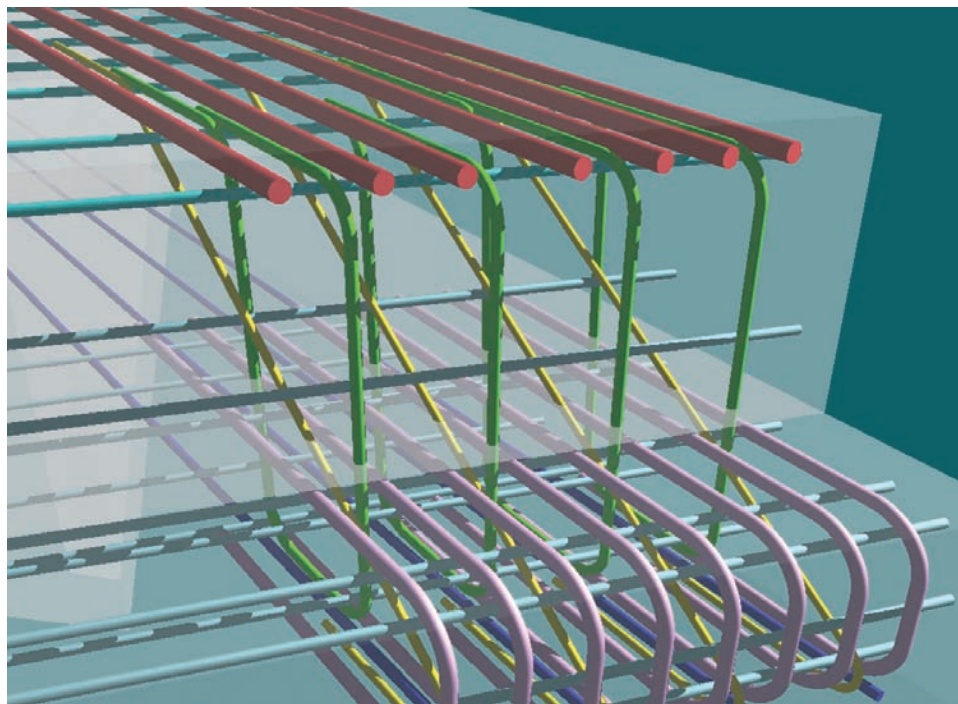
Vue en perspective des armatures de la chaise spécifiées sur les plans
